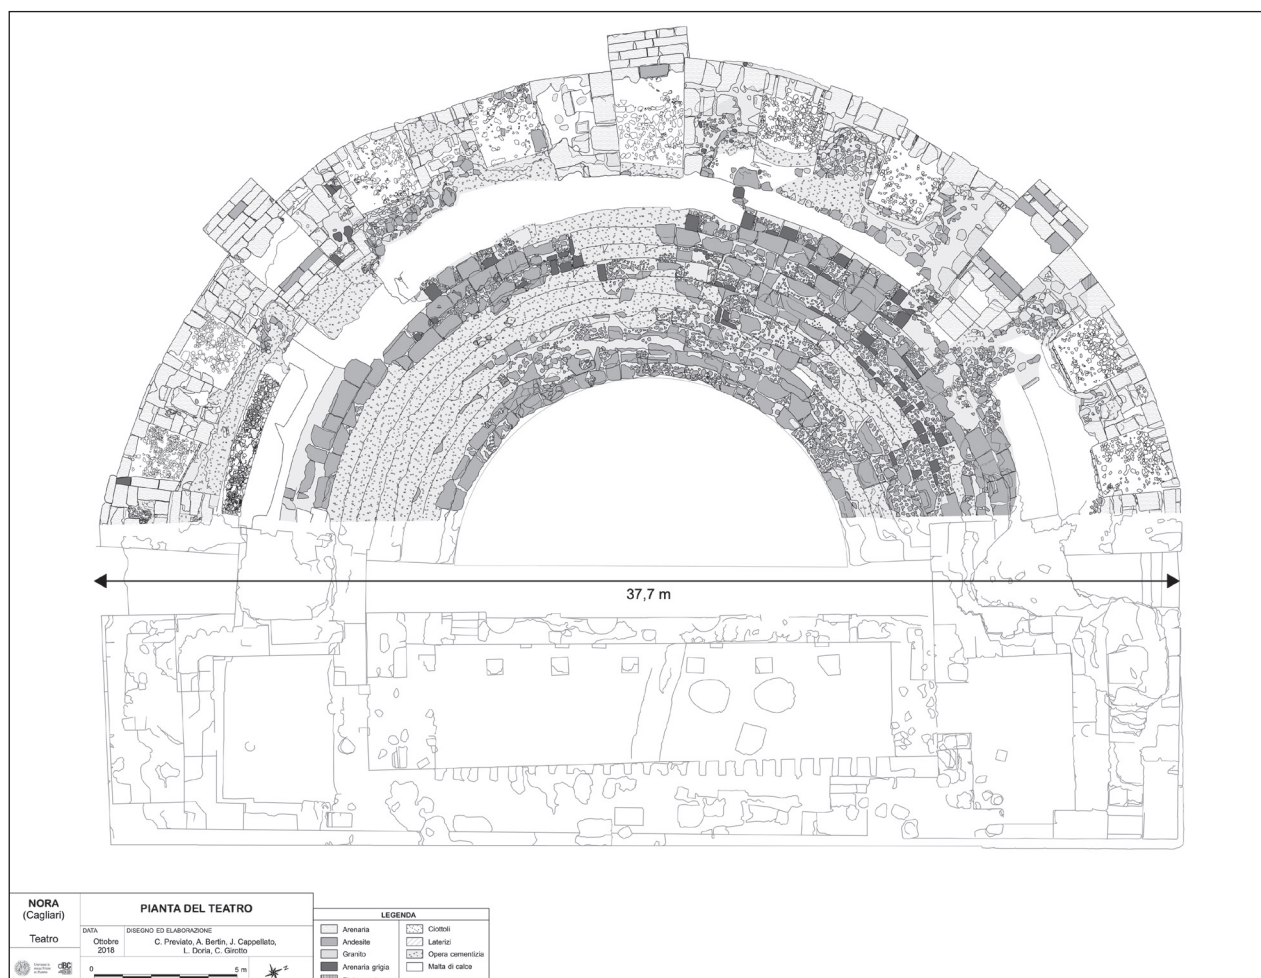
Nora, teatro. Pianta dell'edificio con caratterizzazione dei materiali da costruzione in esso impiegati.
